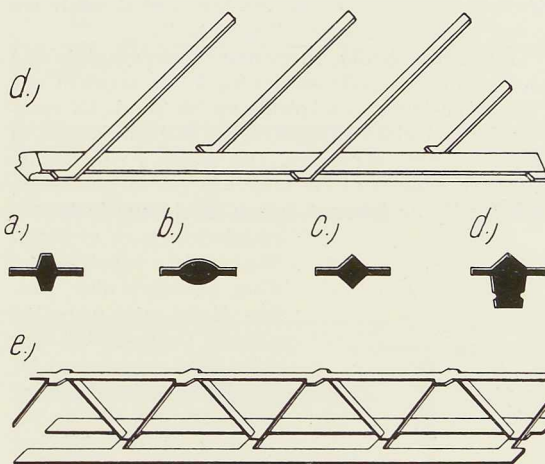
Poutres spéciales devant travailler en liaison avec la dalle en béton.
